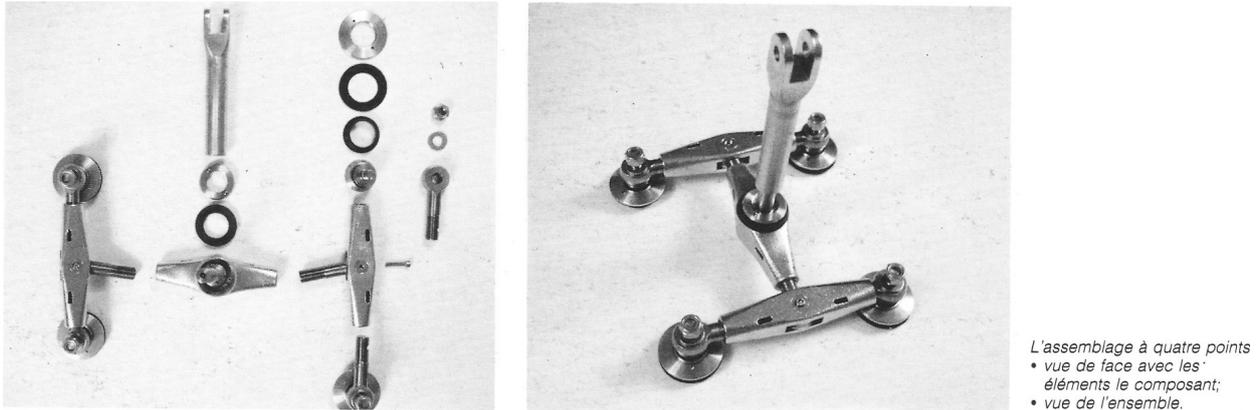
Ensamblaje de cuatro puntos de la fachada de la Villette.
